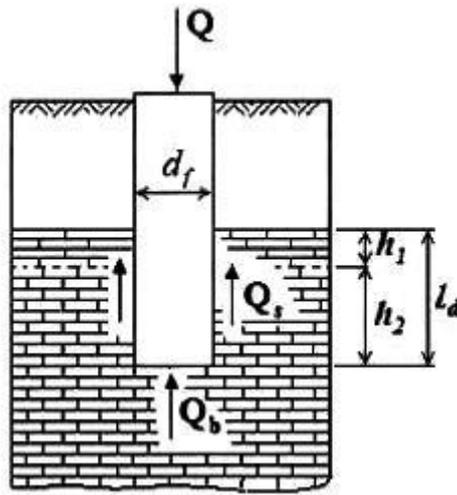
Прорезание сваей толщи скальных грунтов с заделкой
